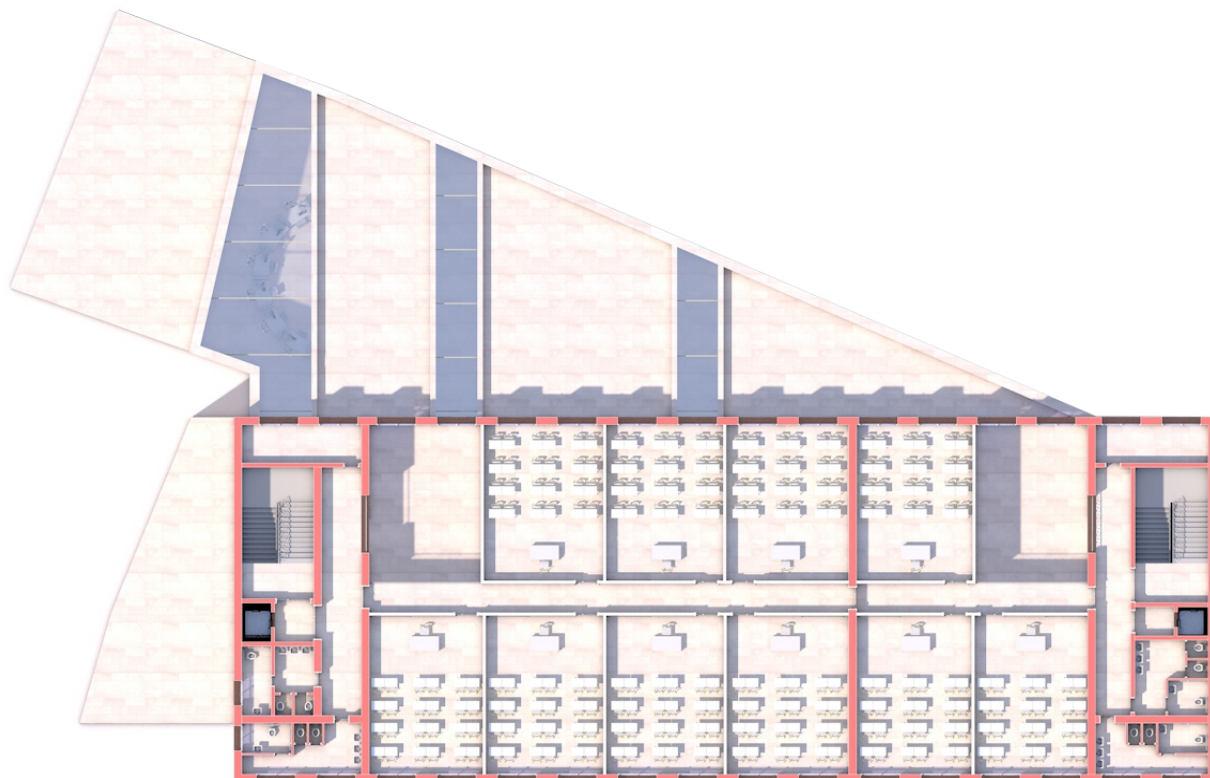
PIANTA QUINTO PIANO – CONFIGURAZIONE CON AULE TRADIZIONALI E SPAZI DI RELAZIONE
